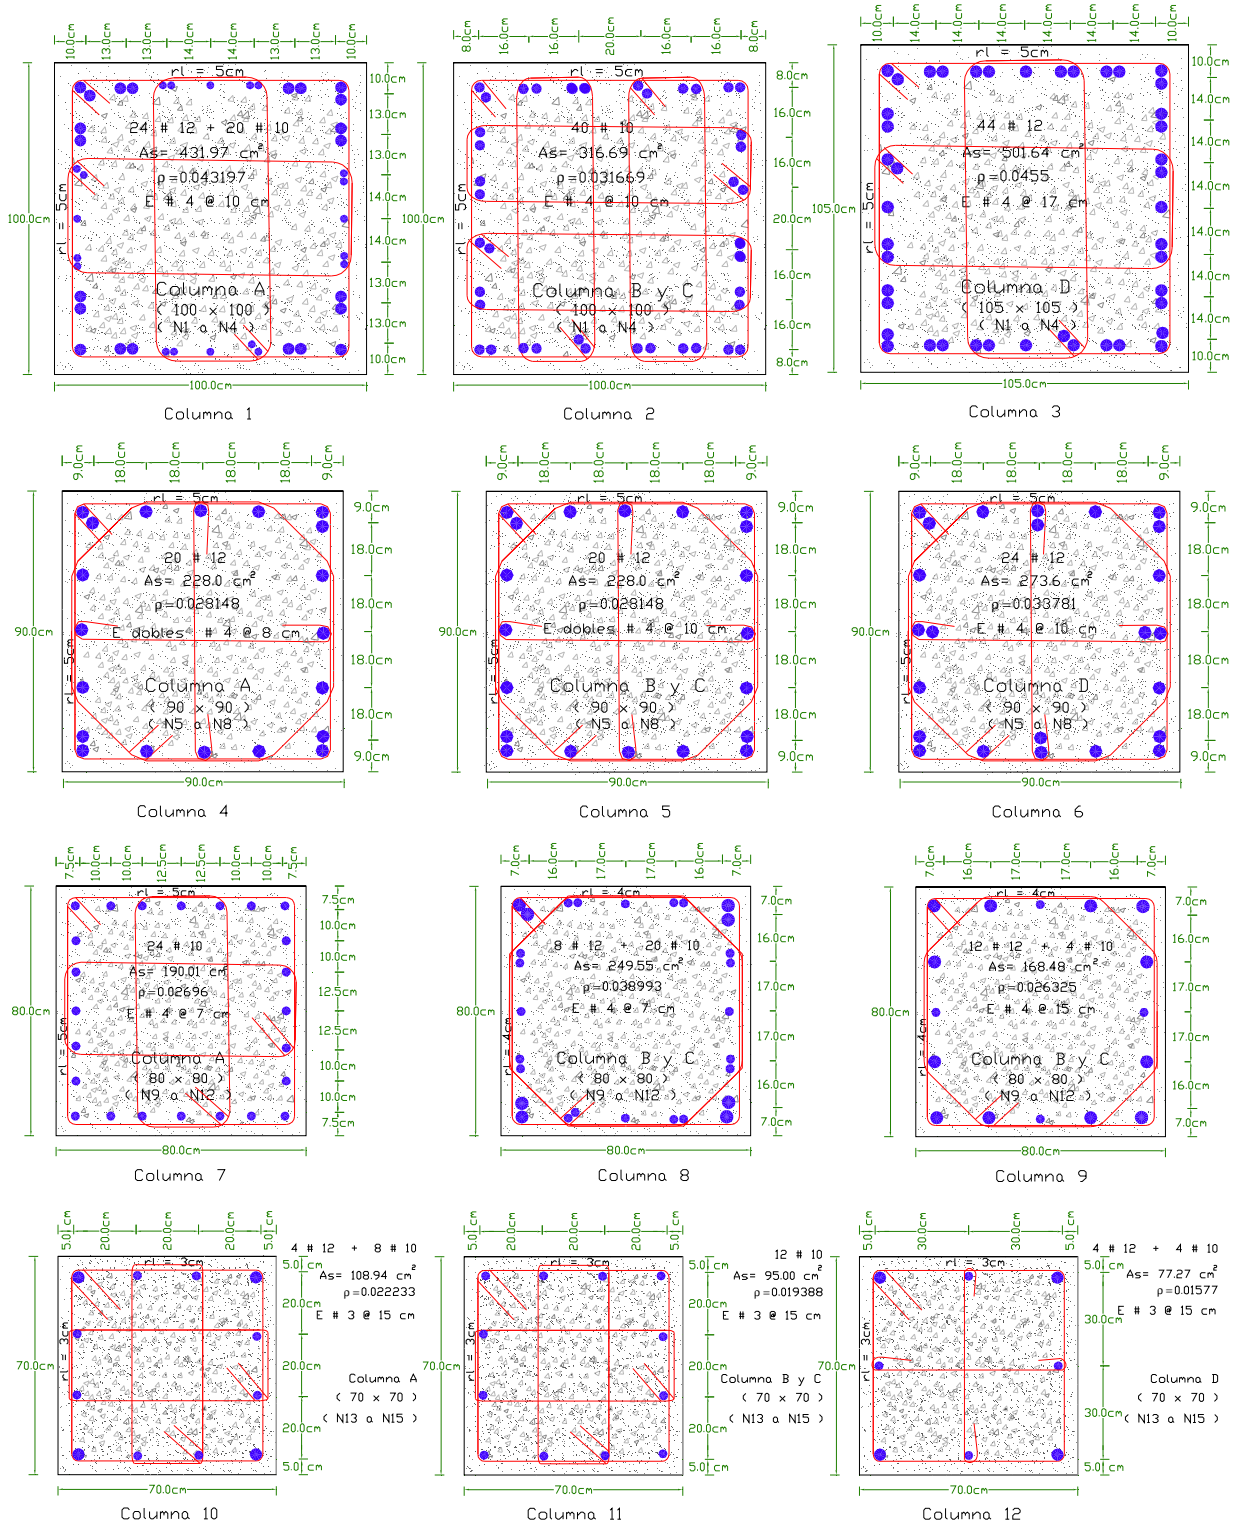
Dimensiones y armado de columnas, edificio III_15
